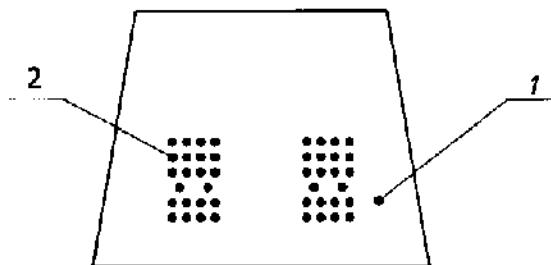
Поперечное сечение бетонной шпалы с композитной арматурой:
